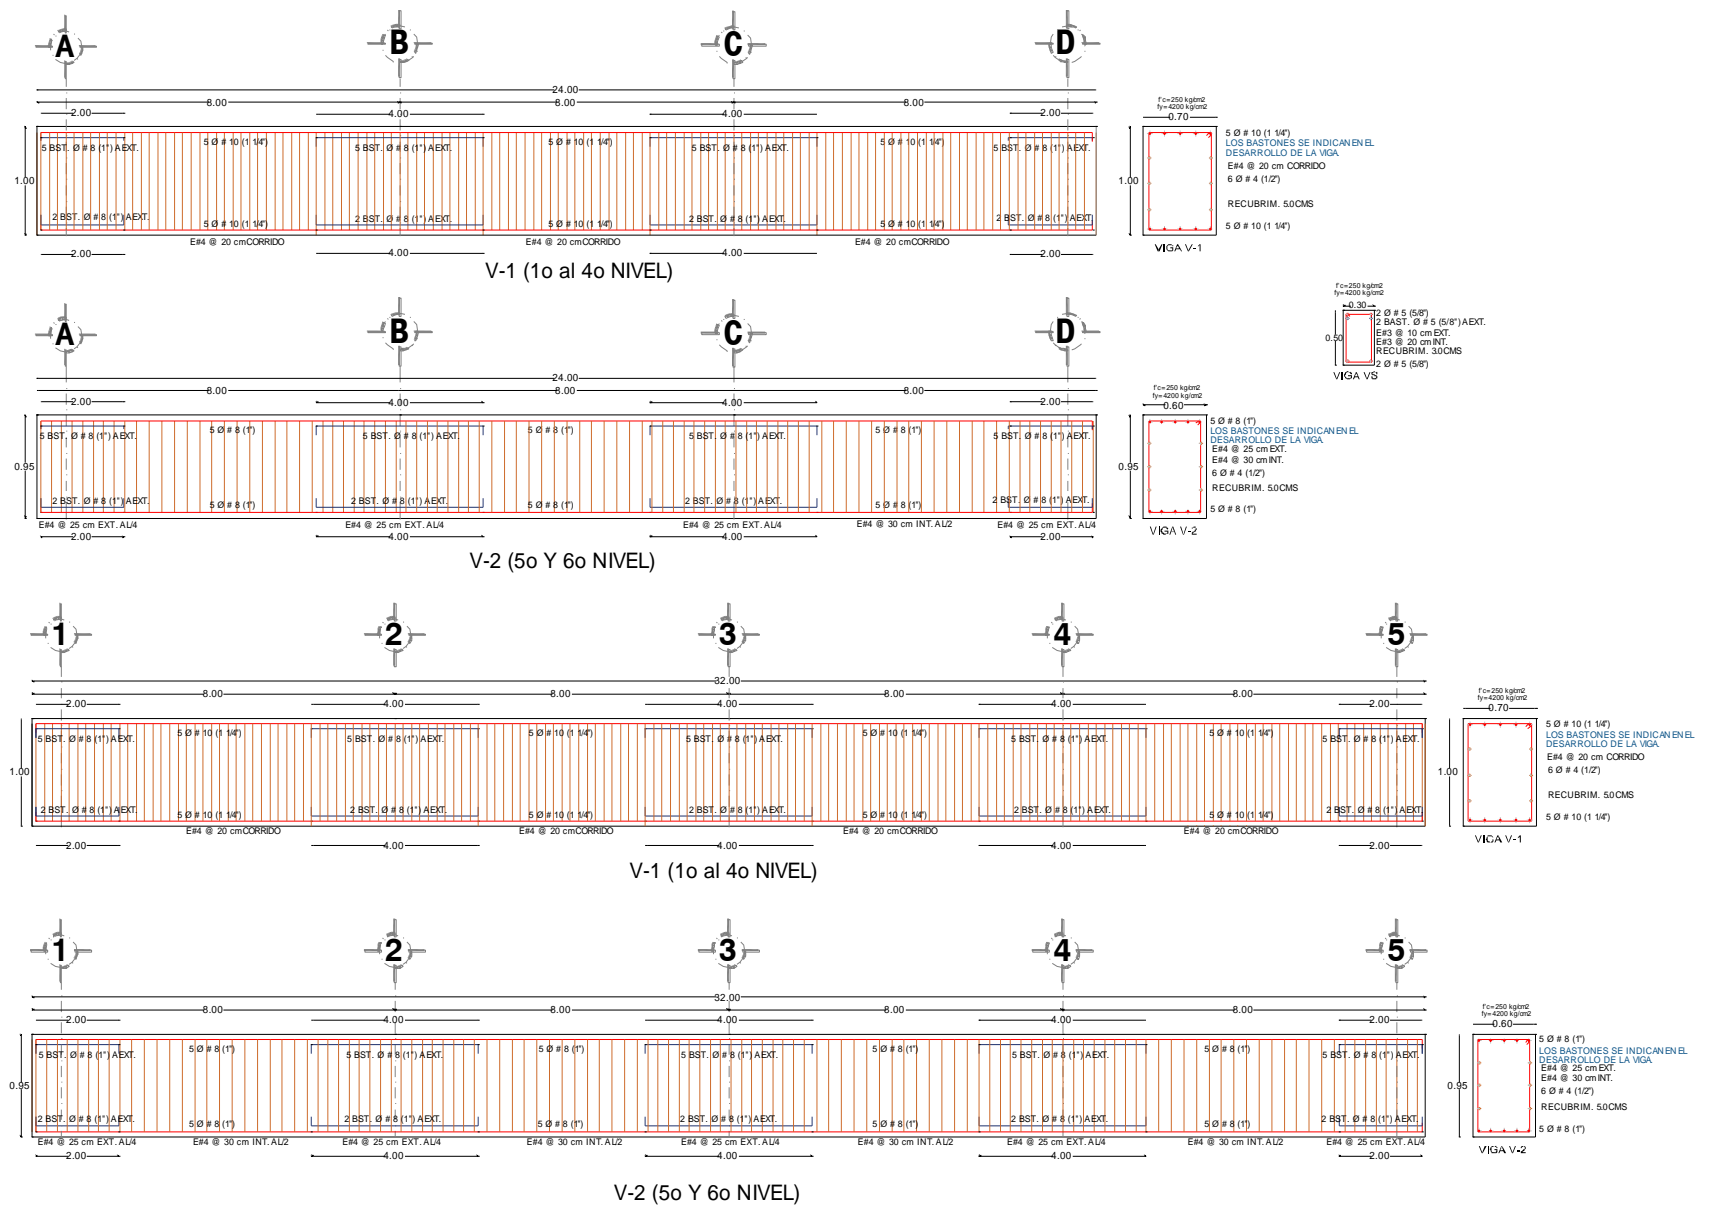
Detallado de armado de vigas de edificio de 9 niveles con base a la hipótesis de las NTCC-04.
